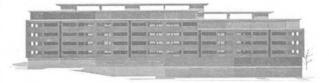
Esquema alzado longitudinal de la volumetría principal.
